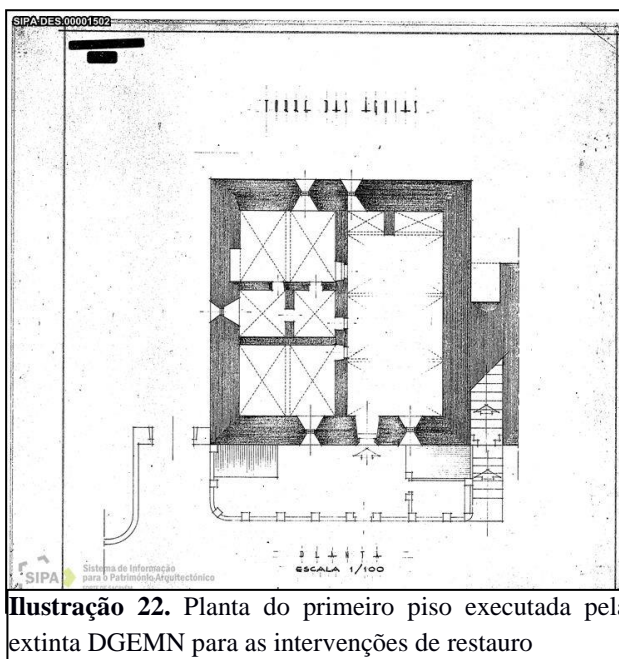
Planta do primeiro piso executada pela extinta DGEMN para as intervenções de restauro
